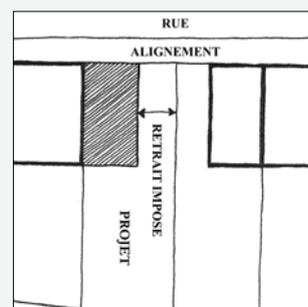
C : projet conforme d'une construction implantée avec retrait latéral imposé.
